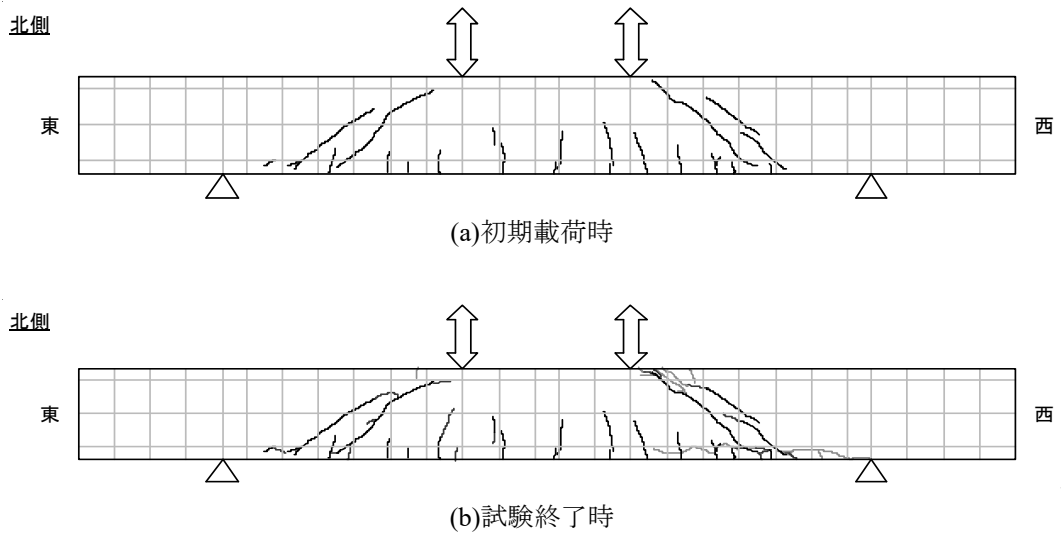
ひび割れ状況(CASE-2)
